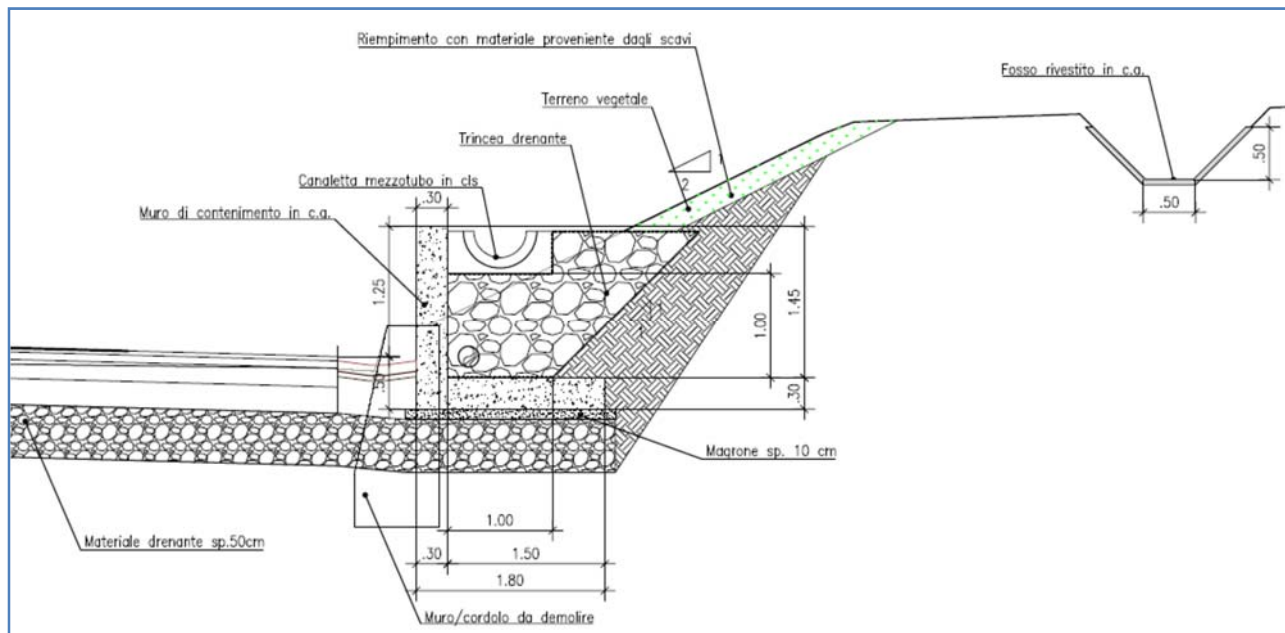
Sezione tipo nuovo muro di contenimento lato monte secondo le previsioni di P.V.T.1 – Elaborato codifica PVVS\_W002\_50\_4137.
